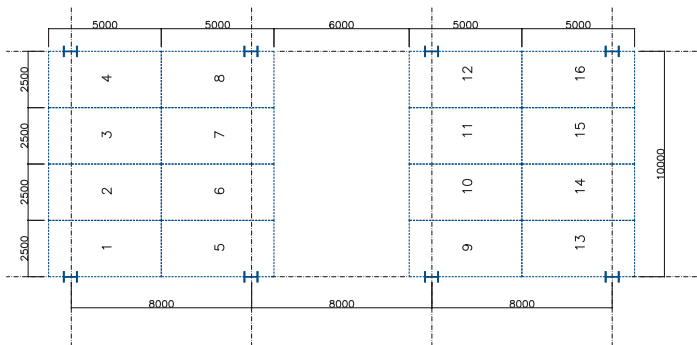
Distribuição das vagas – módulo tipo 4
